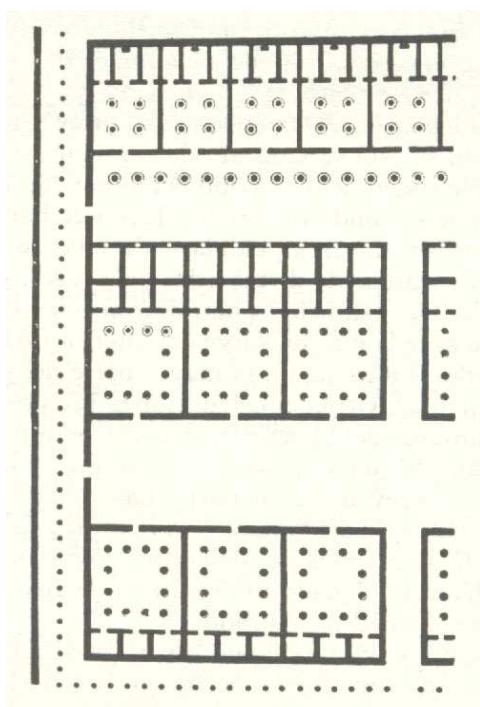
Plano parcial de la planta del laberinto de Hawara según Sir Flinders Petrie.
